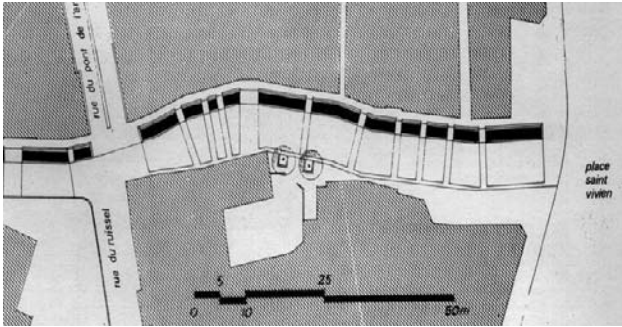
e 16. Progetto di ripristino del canale Robec a Rouen. Planimetrie dell'intervento.
